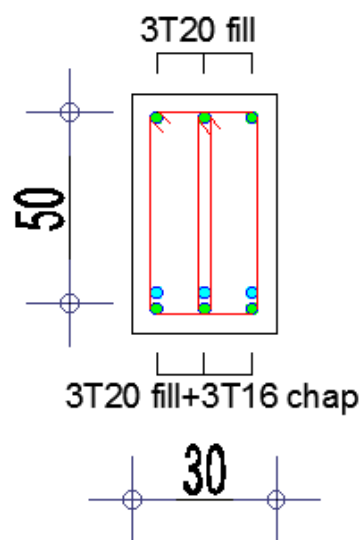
Schéma de ferrailages des Poutres 30x50.
